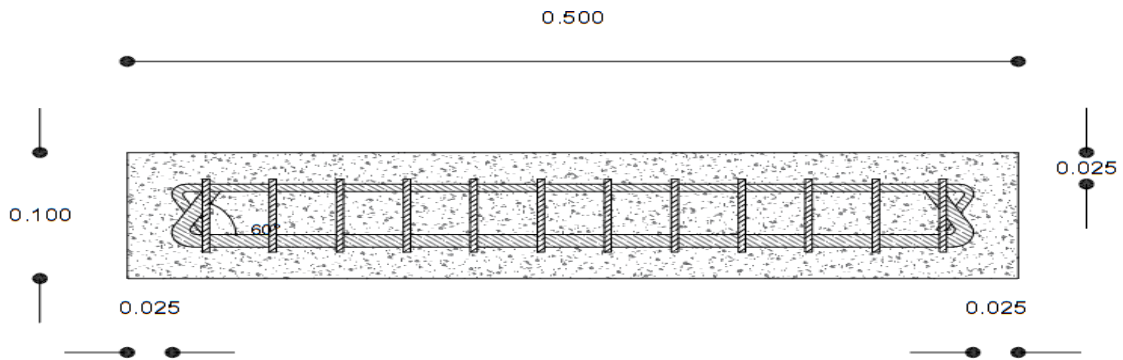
Detalle de armado del ángulo de 0°.
